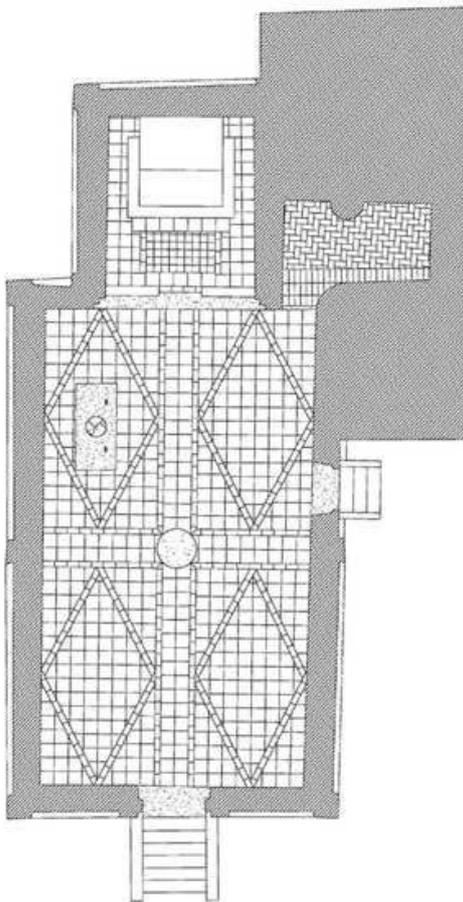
Pianta della chiesetta di Ca' Murà.
